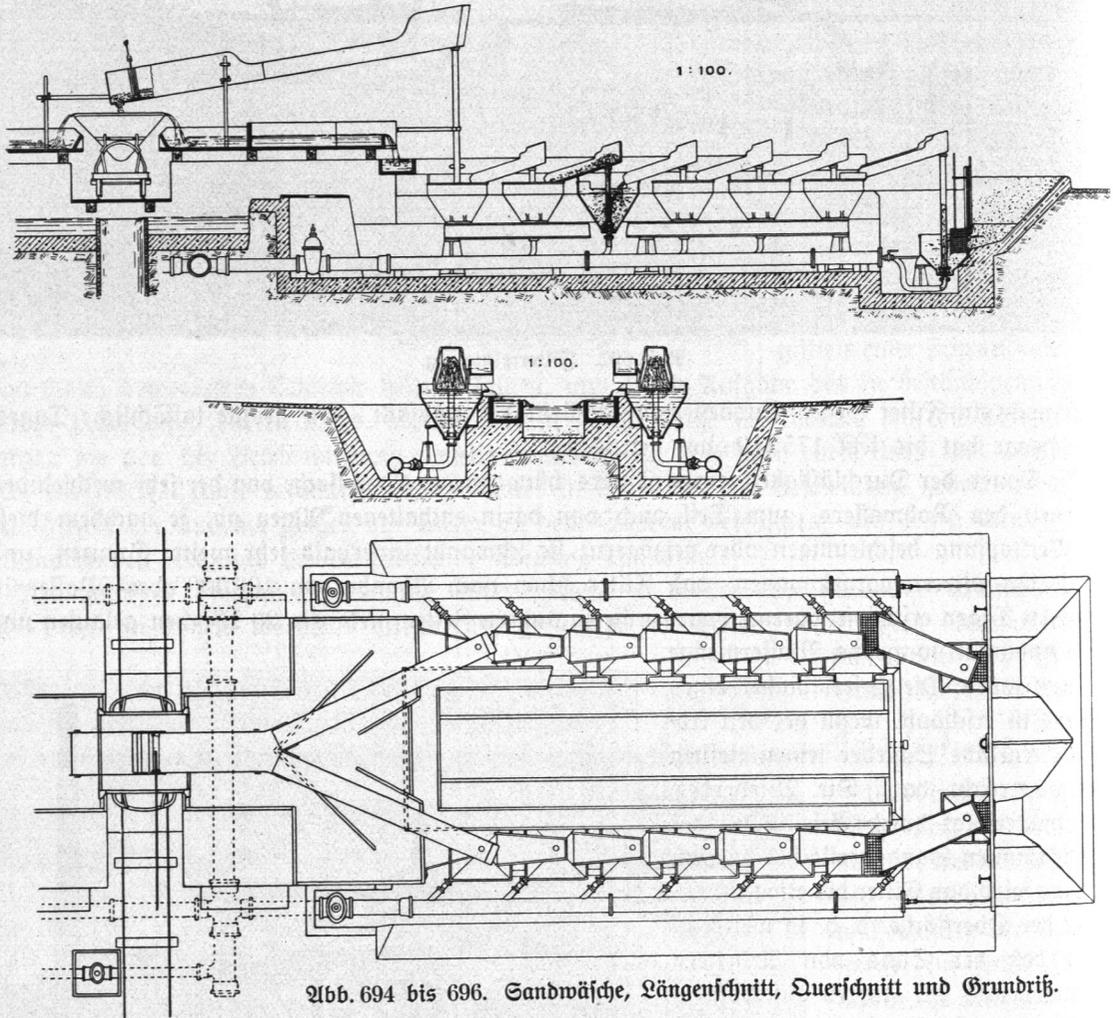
bis 696. Sandwäsche, Längenschnitt, Querschnitt und Grundriß.
